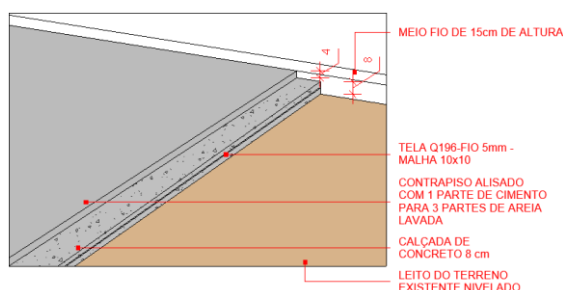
DETALHE GENÉRICO DA CALÇADA EM CONCRETO USINADO ALISADO COM BASE DE 8 CM ARMADA.
